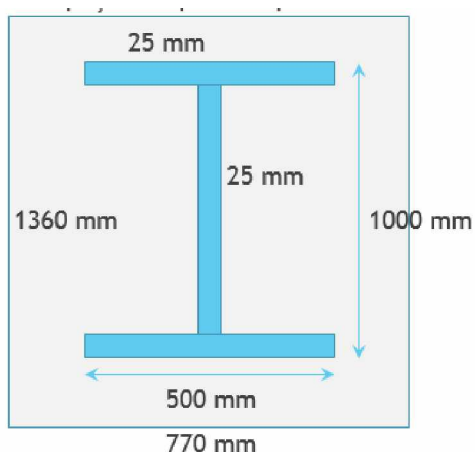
Perfil soldado mais crítico em processo FCAW
